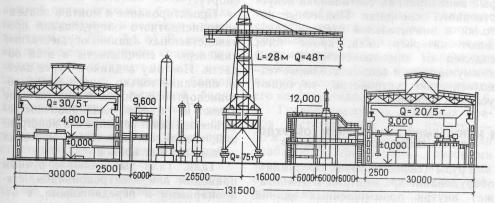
Поперечный разрез промышленного здания со встроенными этажерками
